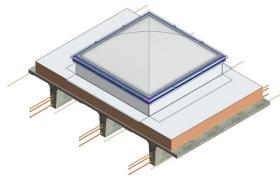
TPO sur l'isolation de toiture et les rabats TPO du WiNa Stairvent sur la TPO de l'isolation de toiture
